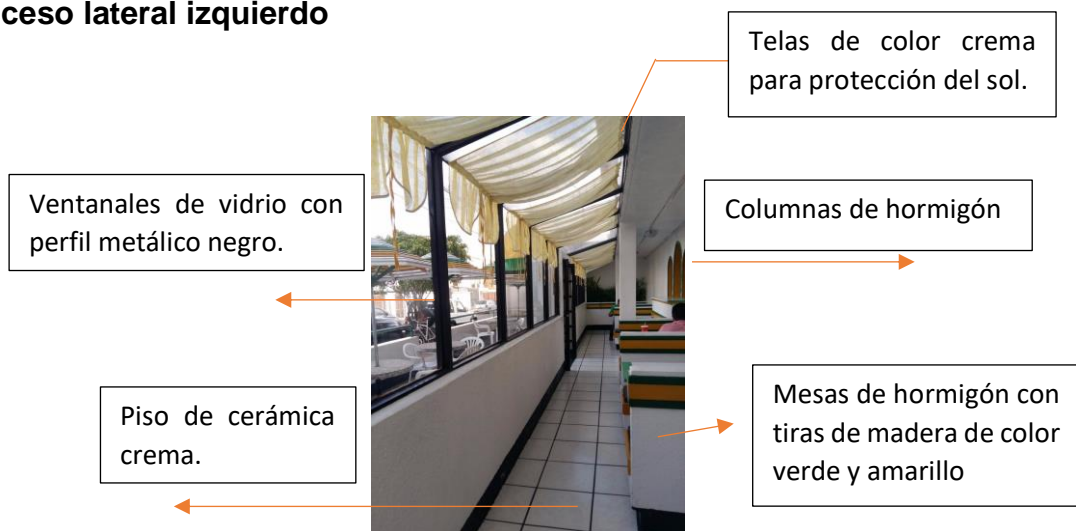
Fotografía actual planta baja- Ingreso lateral.
